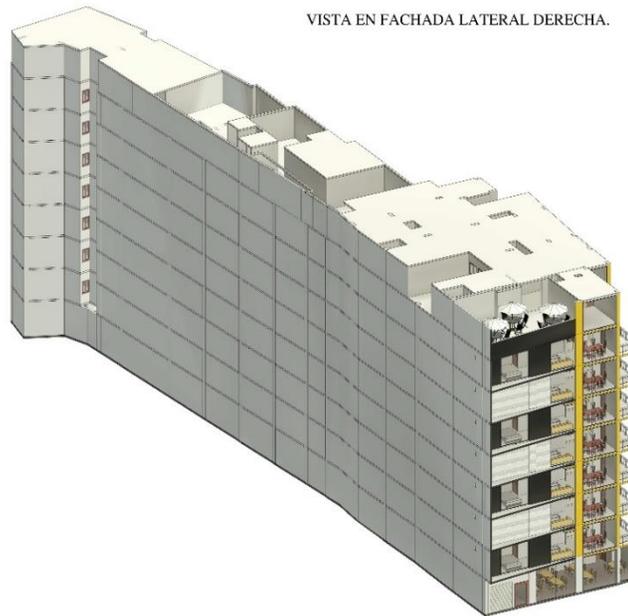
Corte y distribución conjunto residencial el norteño, plano A101. Diseño de: REVIT 2021
